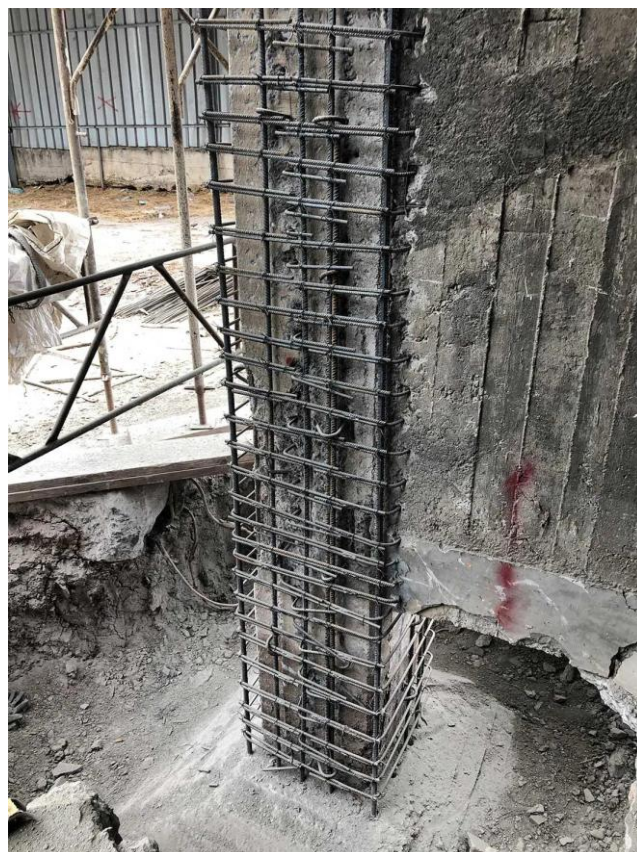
Chemisage en béton armé d'un poteau de rive (détail d'armatures)
